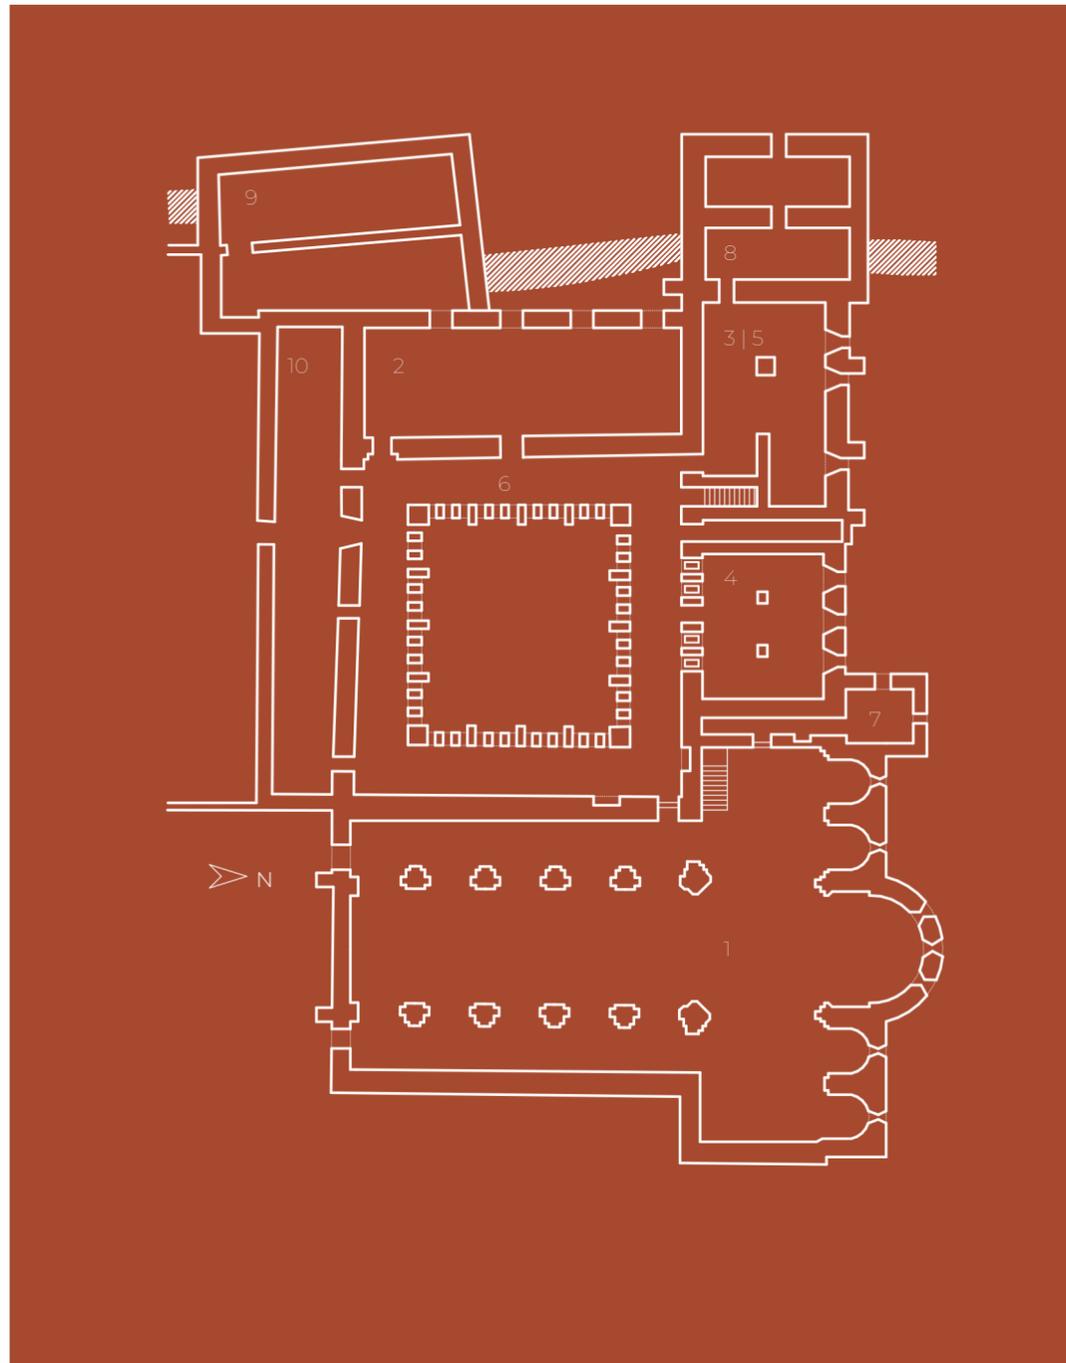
| Notre-Dame de Senanqué Grundriss
